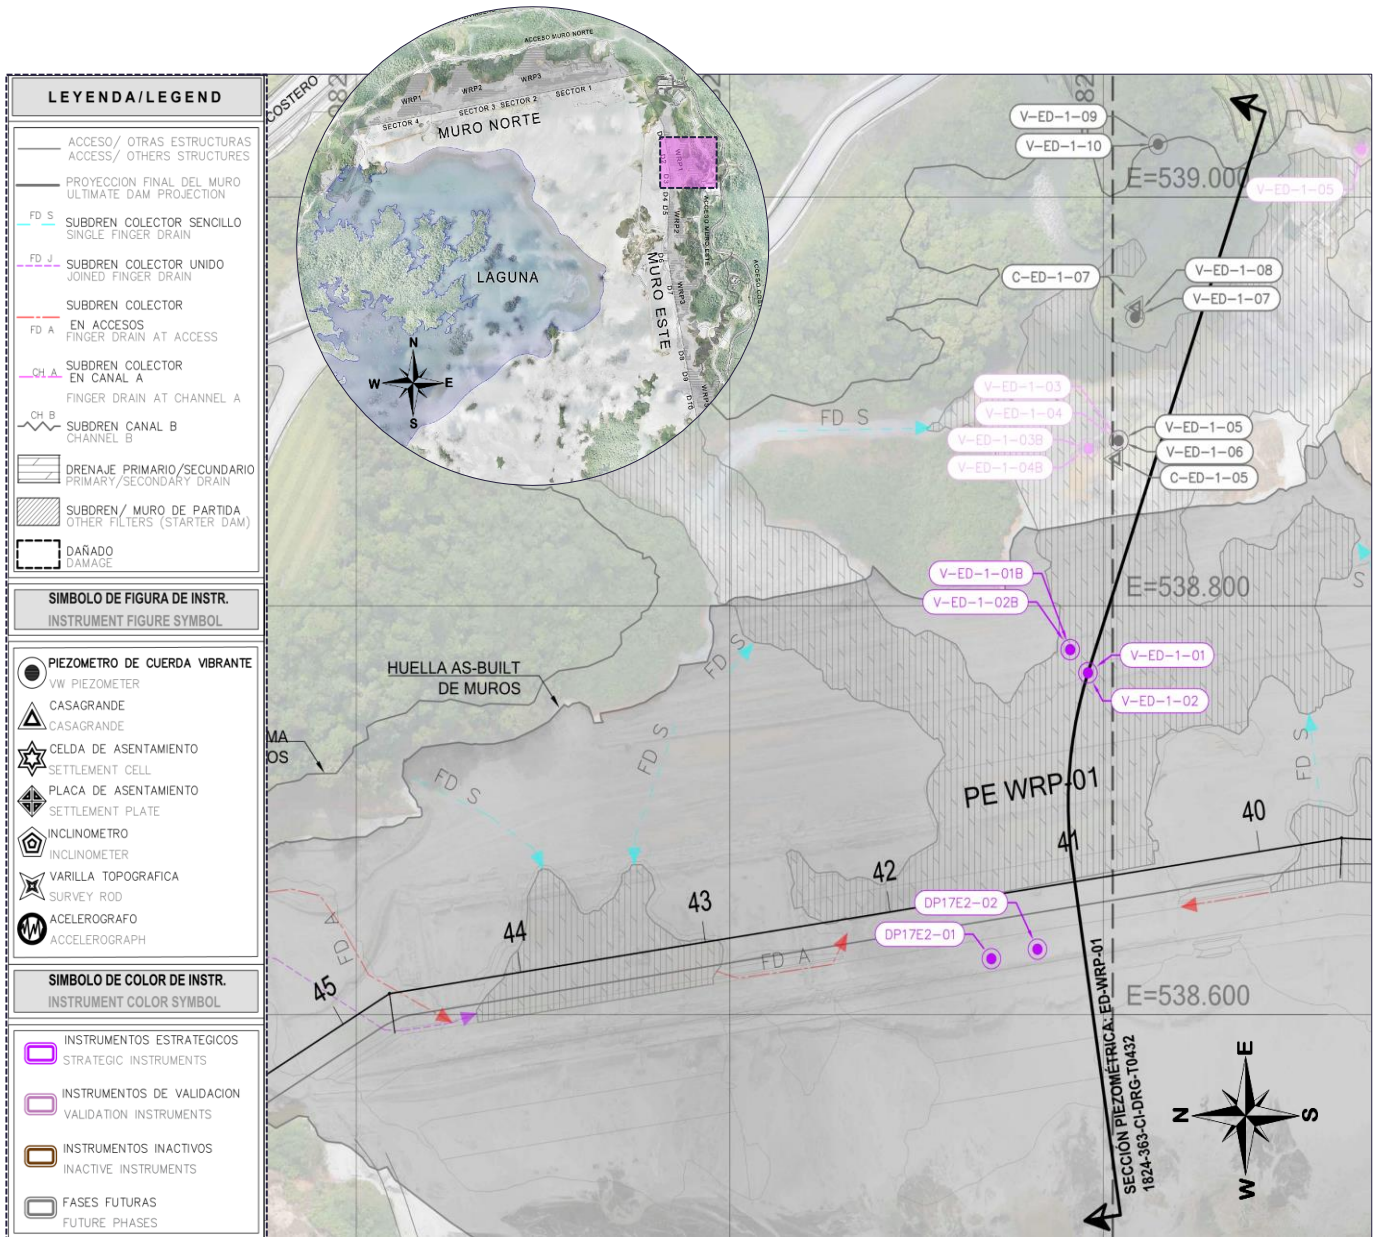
Vista de Planta en el Muro Este WRP1 con Piezómetros
